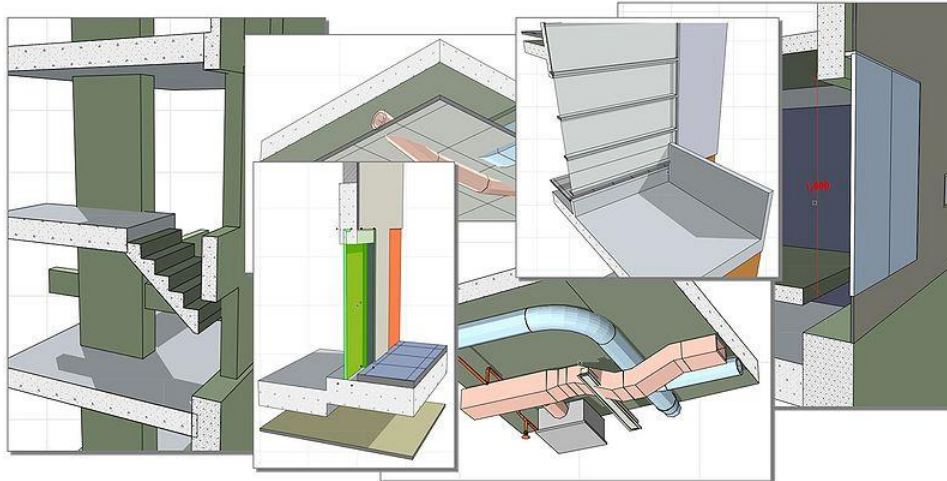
Conjunto de erros e de sobreposições de elementos [23].
